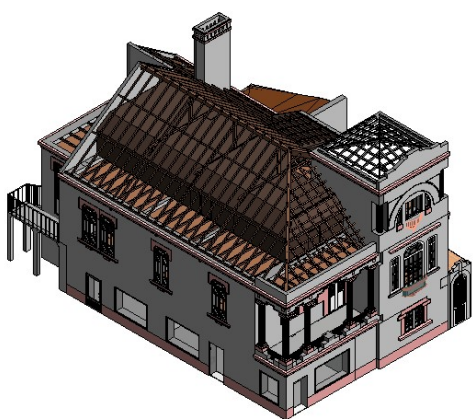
Vista 3D do Modelo BIM (Alçado principal e lateral)
